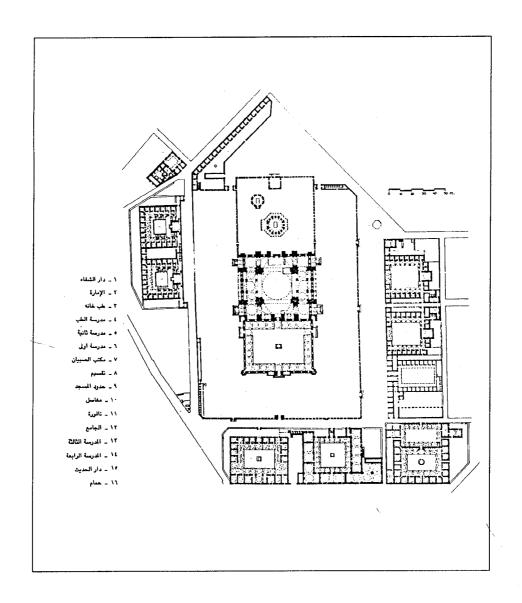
مسقط أفقي لمجمع السلطان الفاتح في إستانبول (عن :ارسيكا) .
